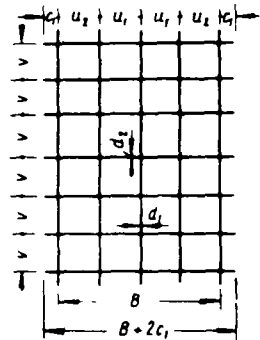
Типы плоских сварных каркасов, изготовляемых на автоматических машинах
